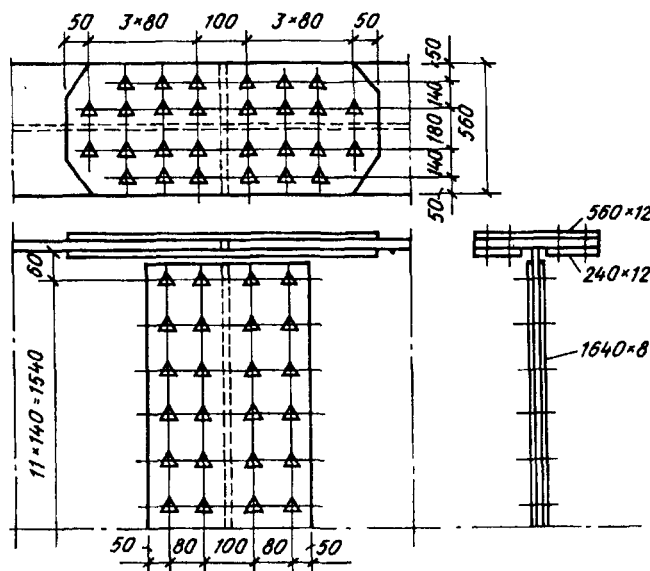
Монтажный стык сварной балки (пример 7.8)
